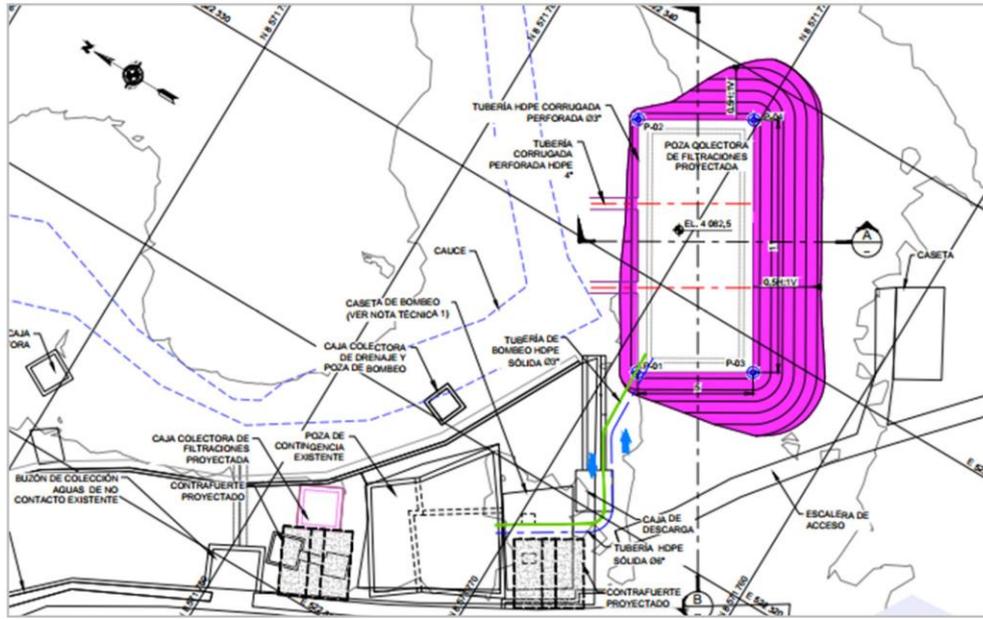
Vista en planta de la ubicación de los contrafuertes del muro proyectados
